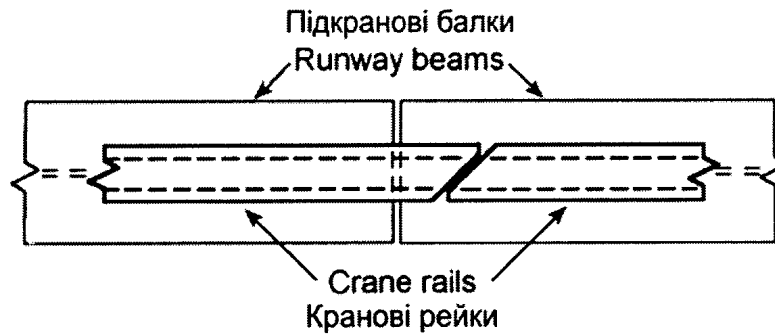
Зміщення стику з косими кромками рейки крана
